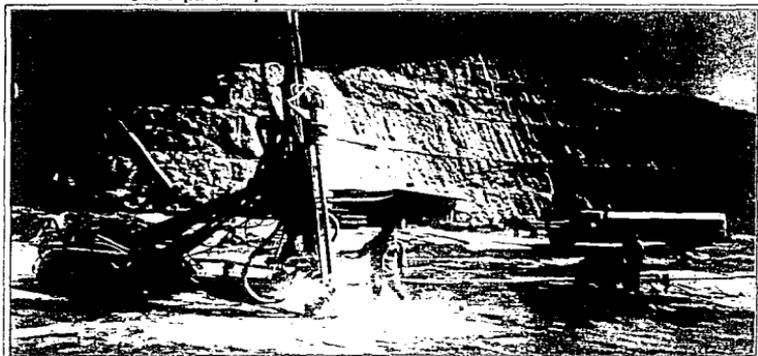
Equipo de perforación empleado en el exterior de las galerías, track drill, en la parte inferior derecha se aprecia la operación de inyectado de un barreno de pantalla profunda.
